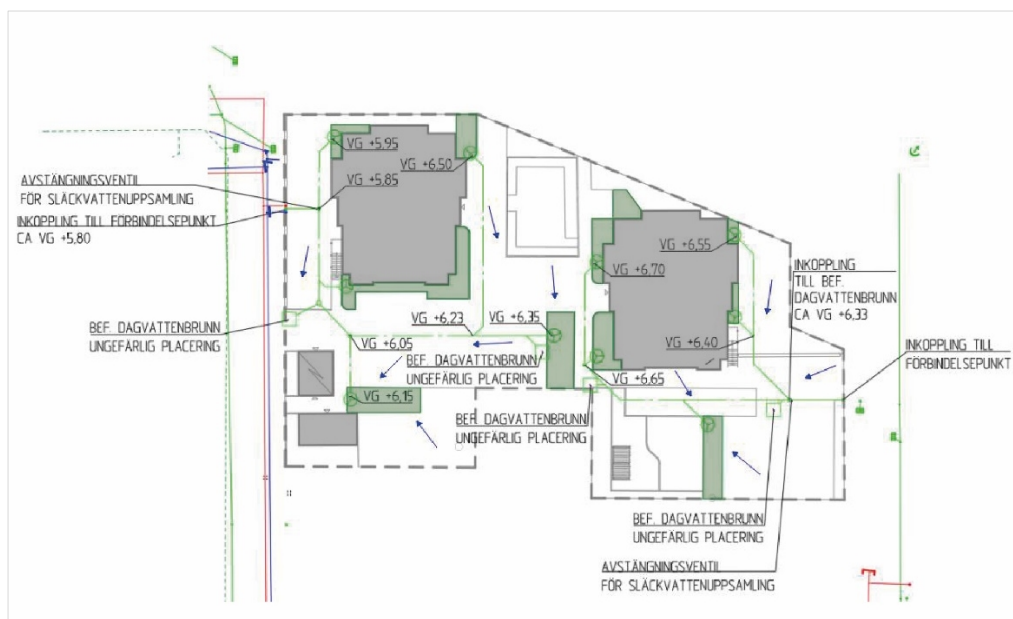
Illustrationsplan som visar föreslagen dagvattenhantering. Förslag på ytlig avrinning visas med blå pilar och placering av regnbäddar är markerade i mörkgrönt. *Illustration: PE Teknik & Arkitektur
